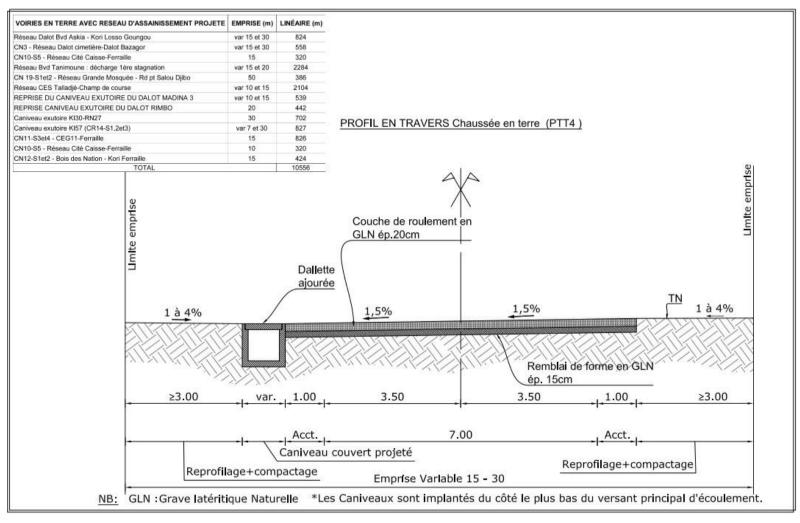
Profil en travers type 4 – Chaussée en terre (PTT-4)
